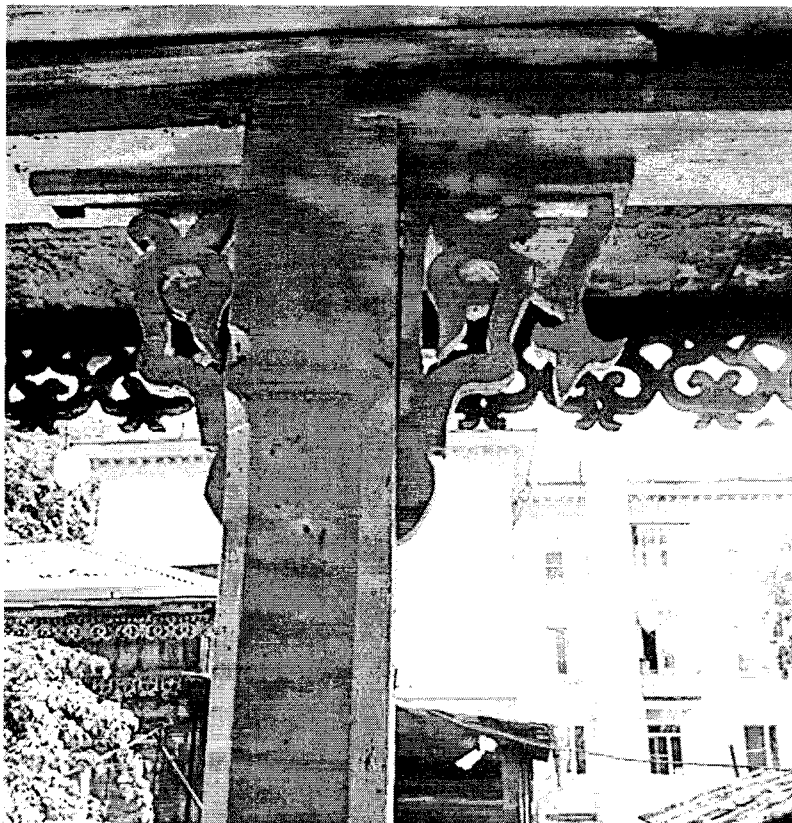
Фрагменты продольного, дворового (северо-восточного) фасада открытой галереи, 2-ой этаж. Столбы ограждения балкона
